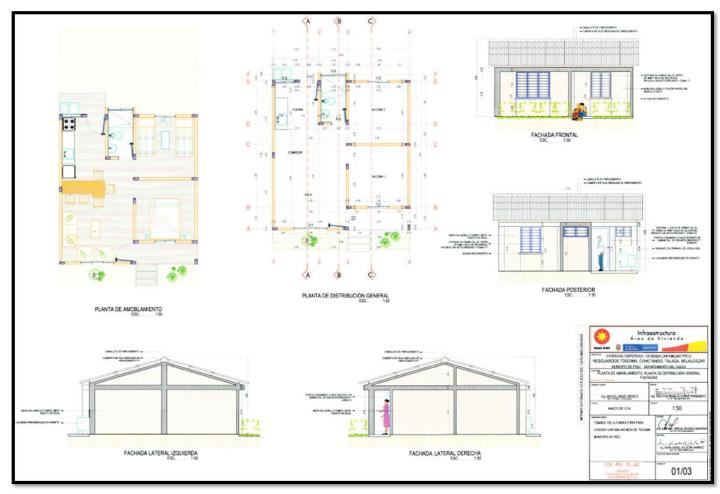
Plano arquitectonico, planta de amoblamiento, distribucion y fachadas de la vivienda tipo 2.
